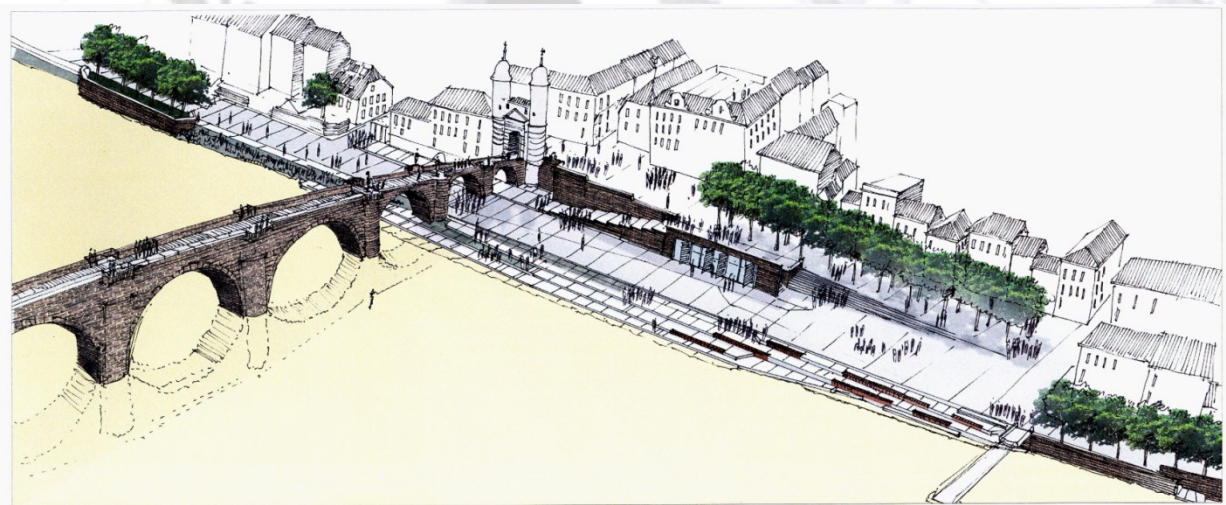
Konzeptskizze Lageplan Neckaruferspomenade ²
